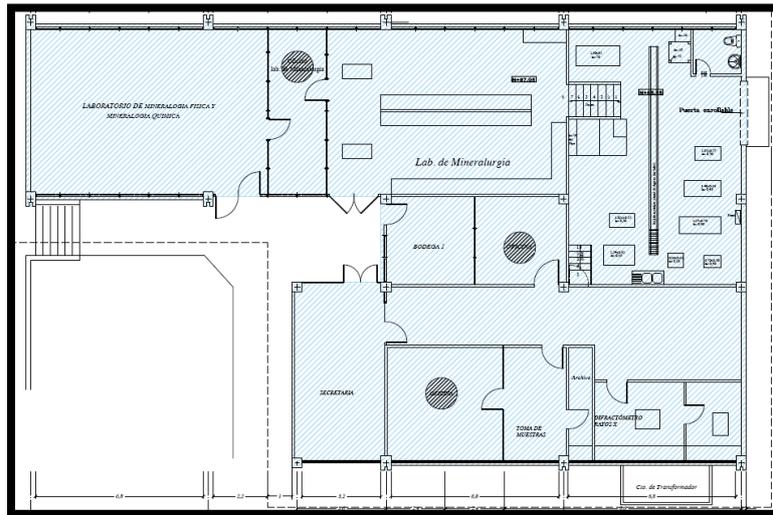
Planos, planta alta, Edificio 20-A, Zona 1
